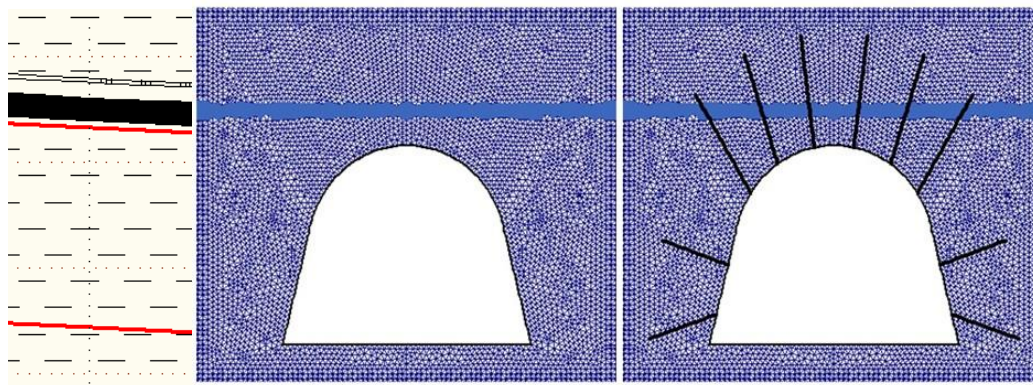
Водонасыщенный угольный пропласток над выработкой
